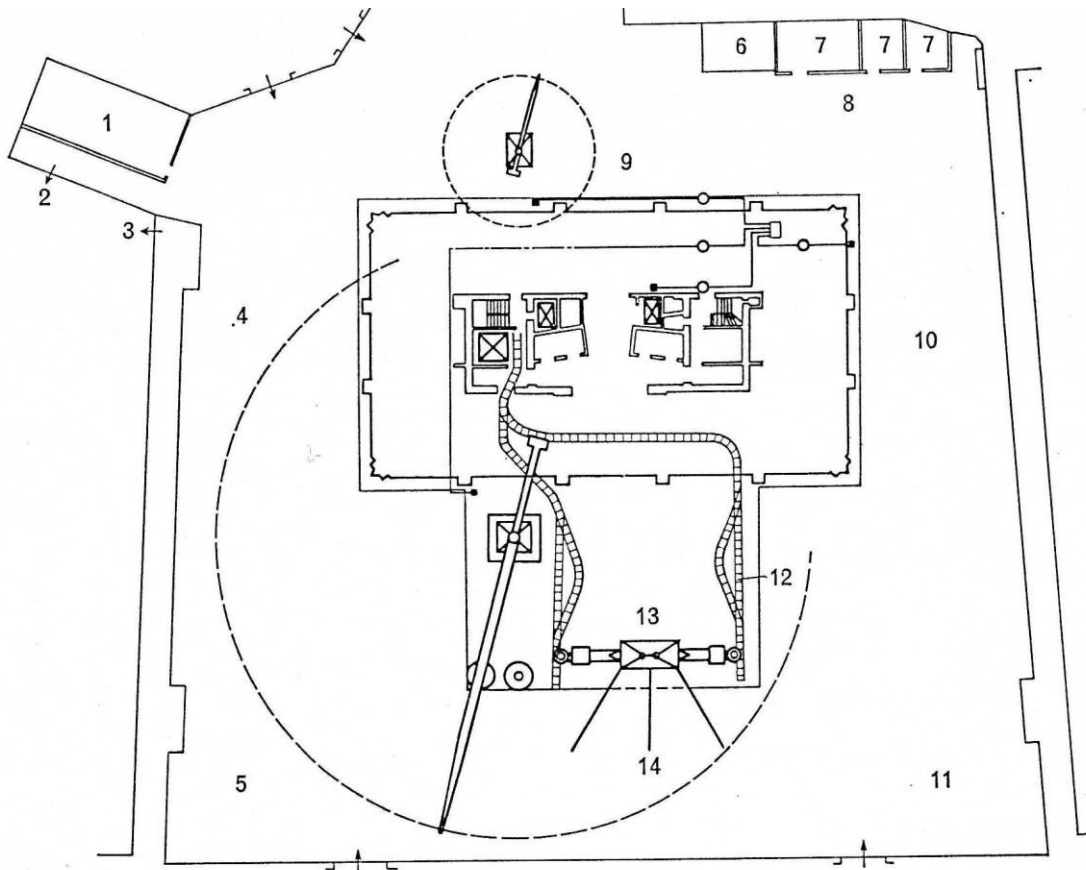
Schema dell'impianto di un cantiere. La disposizione planimetrica della centrale di betonaggio e delle zone di deposito dei materiali fu studiata in modo da ottenere il massimo rendimento dei mezzi di sollevamento (cantiere della « Torre Velasca », dalla Rivista « Costruzioni », Milano).
